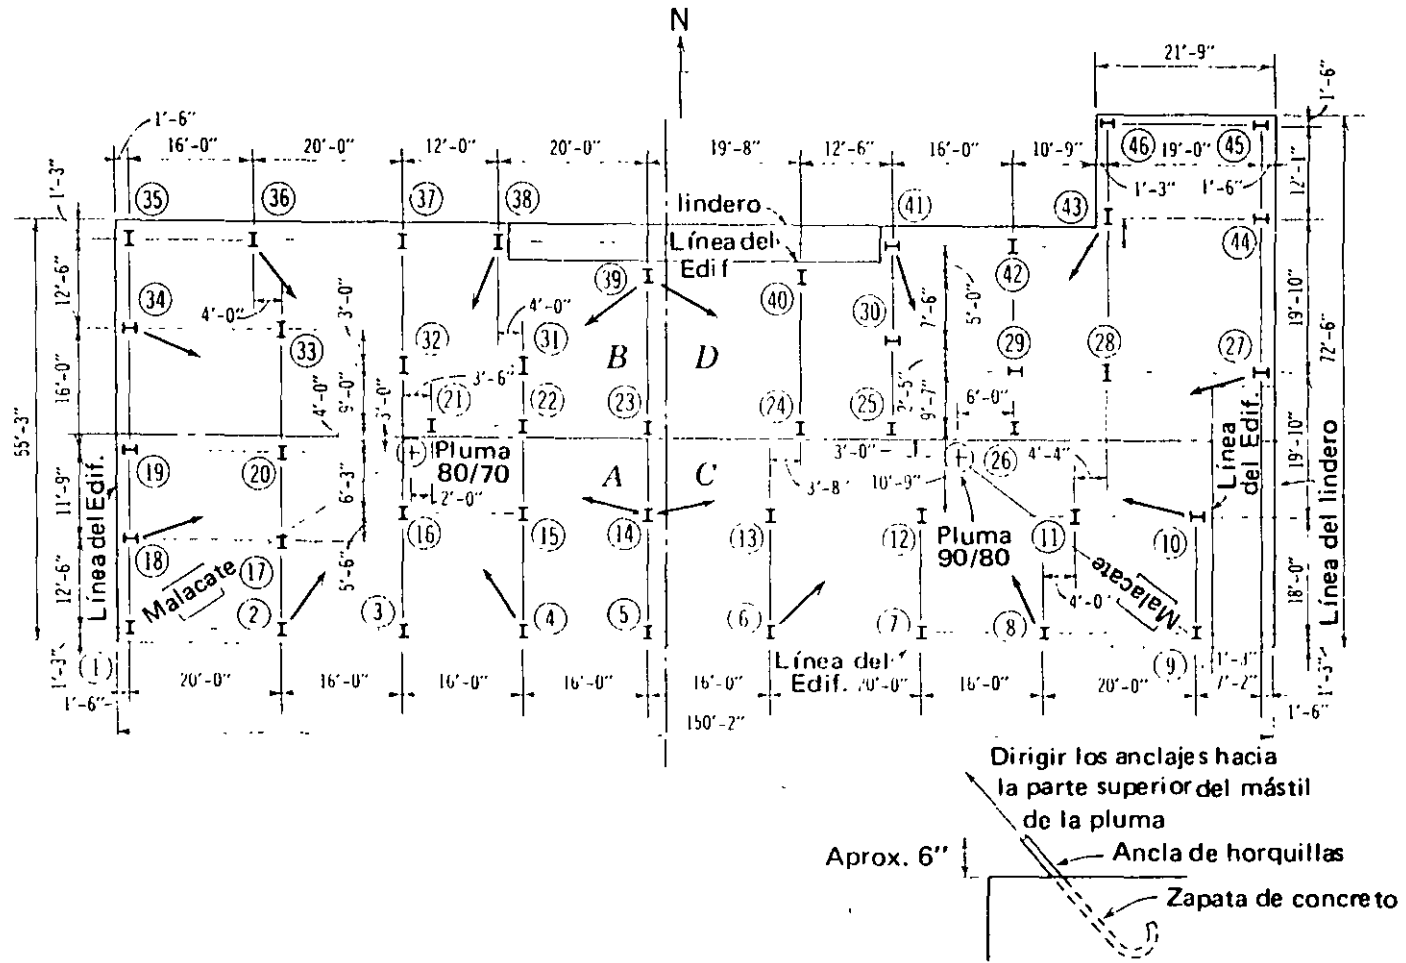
Croquis típico para la colocación de anclajes para una grúa de tirantes.
